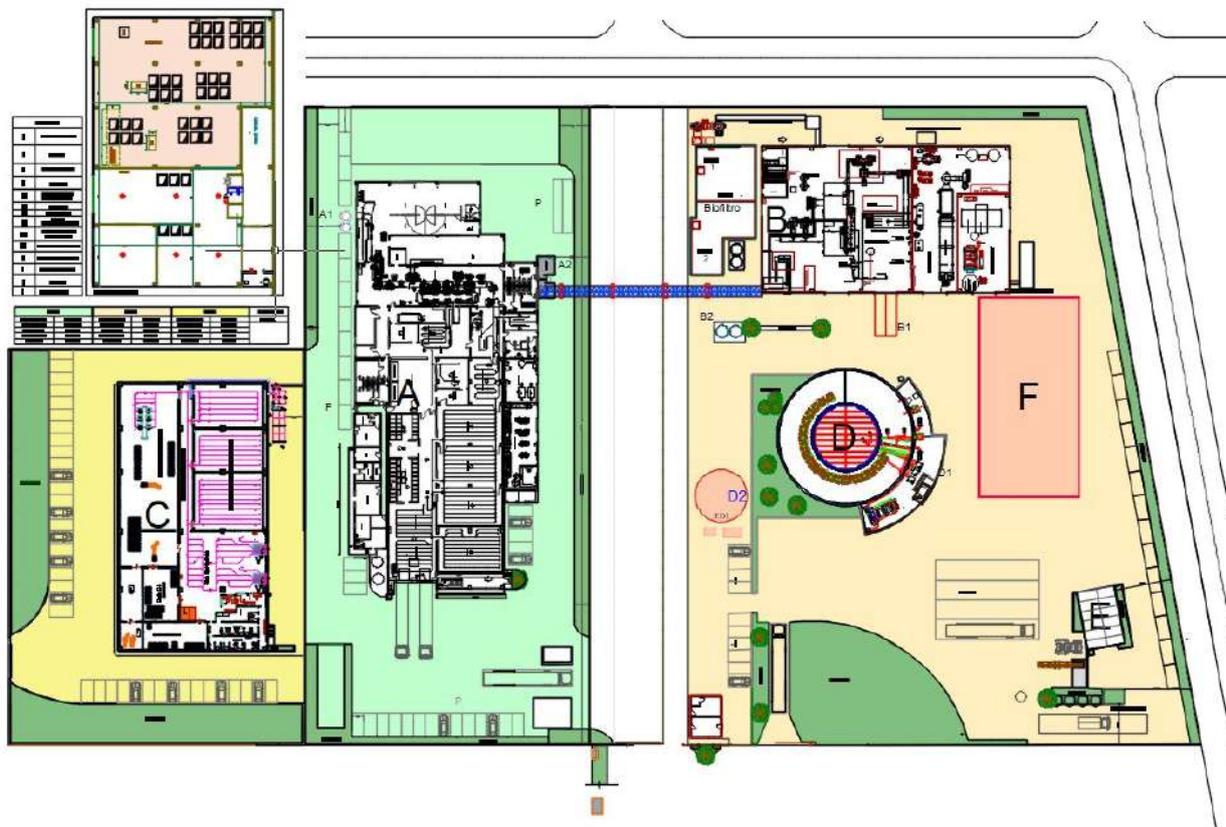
layout dello stabilimento come da planimetria dello stato attuale
